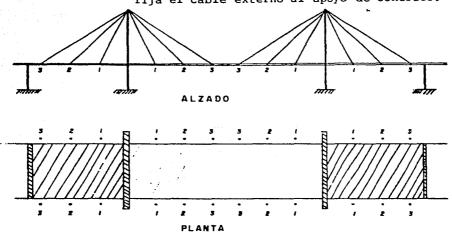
VISTA LONGITUDINAL Y PLANTA DE PUENTE QUE INDICA LA POSICION SERIADA DE LOS CABLES PARA PROCEDER-ORDENADAMENTE A SU TENSADO.
